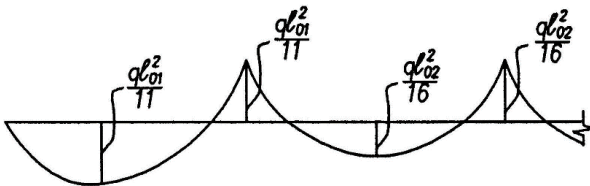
Эпюра изгибаемых моментов: l – расстояние в осях перекрытия
